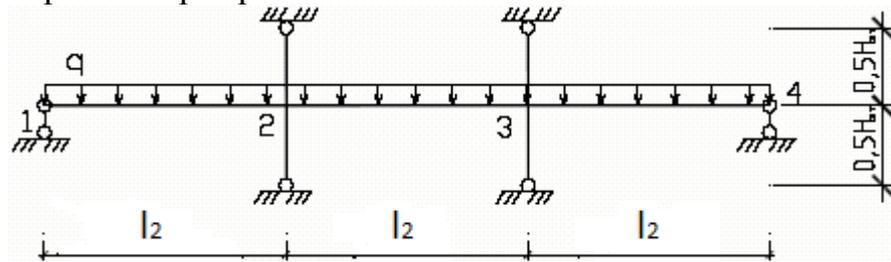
Расчётная схема одноэтажной рамы (цифрами обозначены номера опор).
